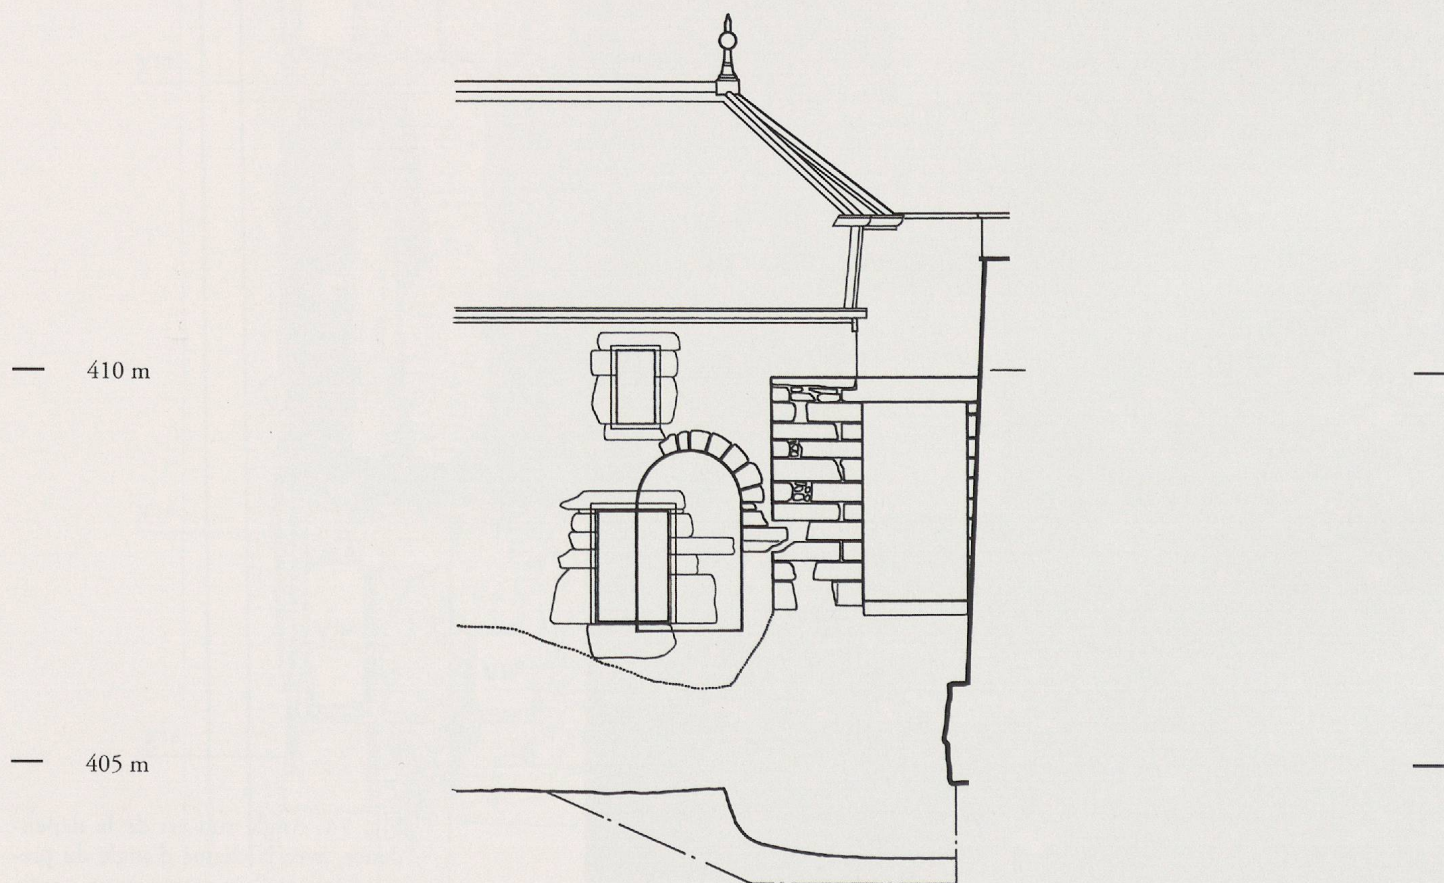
Extrémité est de la façade sud de la dépendance (éch. 1:100).
